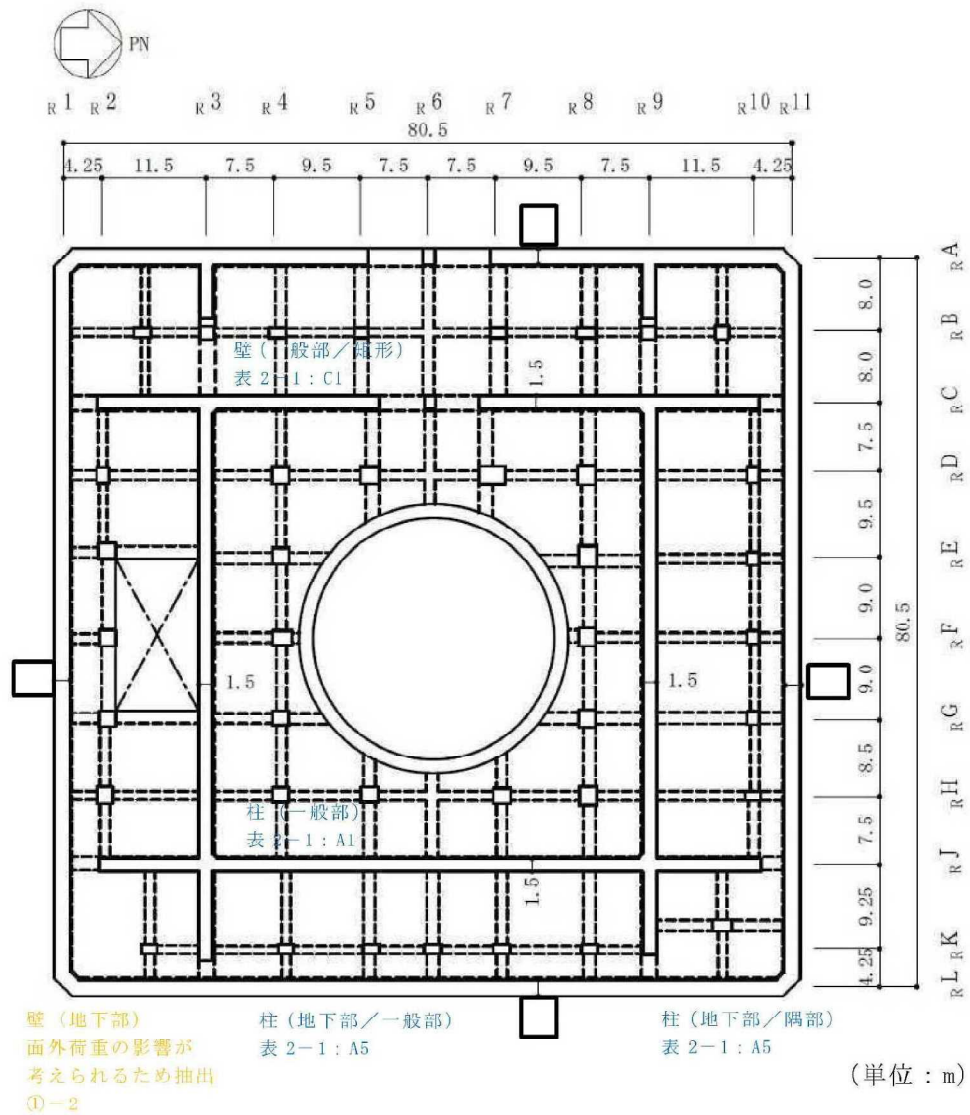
5号機原子炉建屋の概略平面図 (B1F, T.M.S.L. 5.3m) (4/9)
